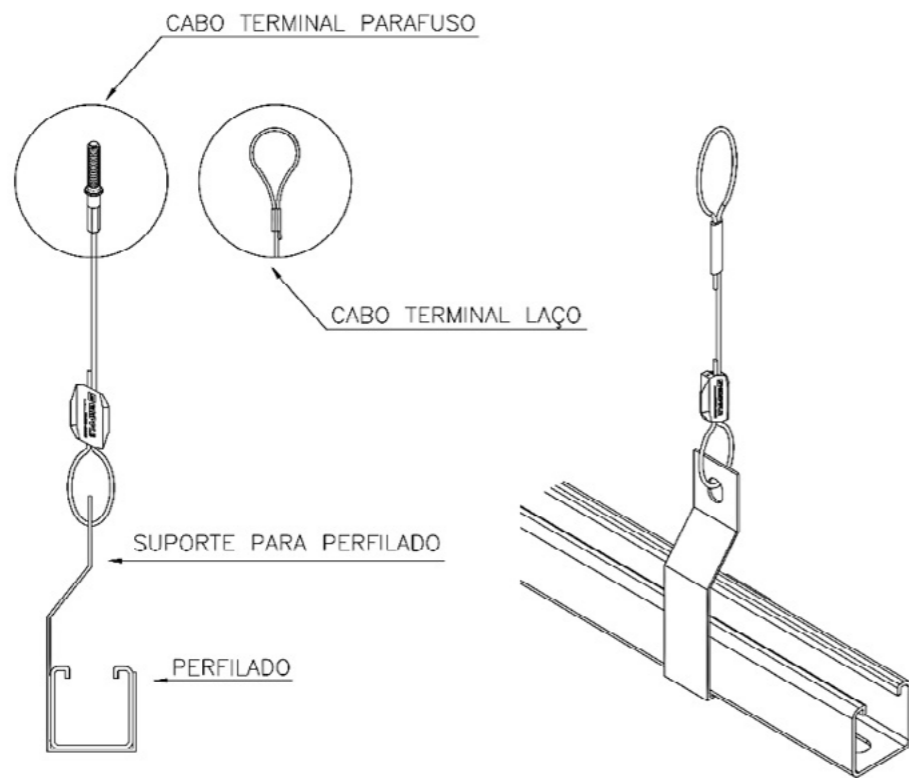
Modelo de fixação de perfilado em laje ou estruturas
